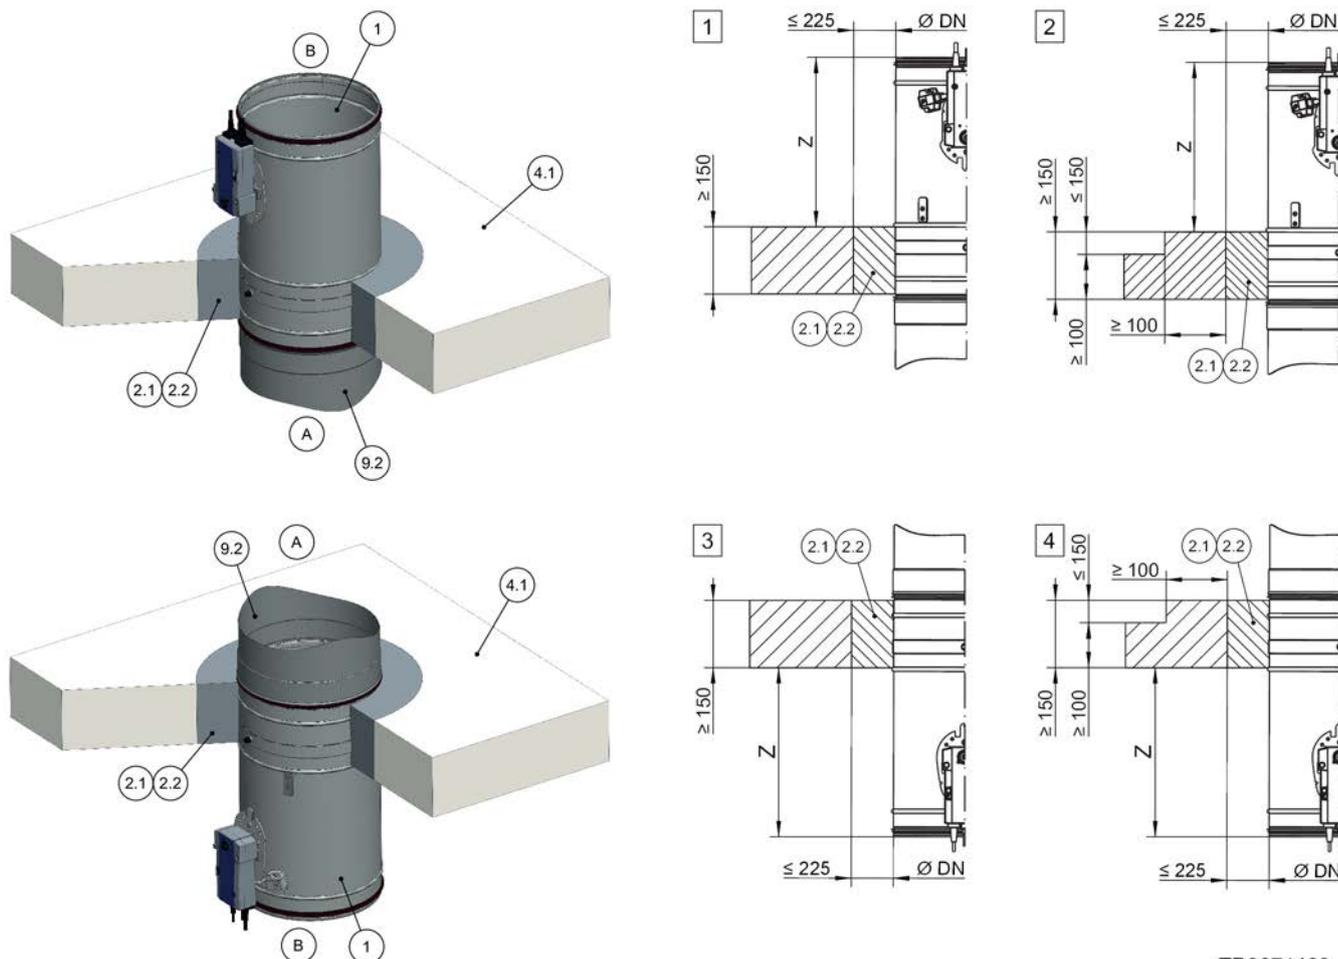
Tetos maciços – disposição/distâncias, disposição lado a lado a título de exemplo
